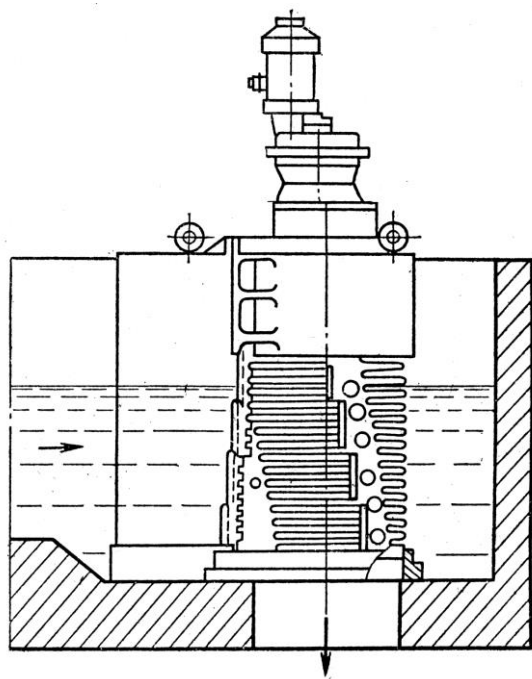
Вид решетки-дробилки РД-600 в канале.
